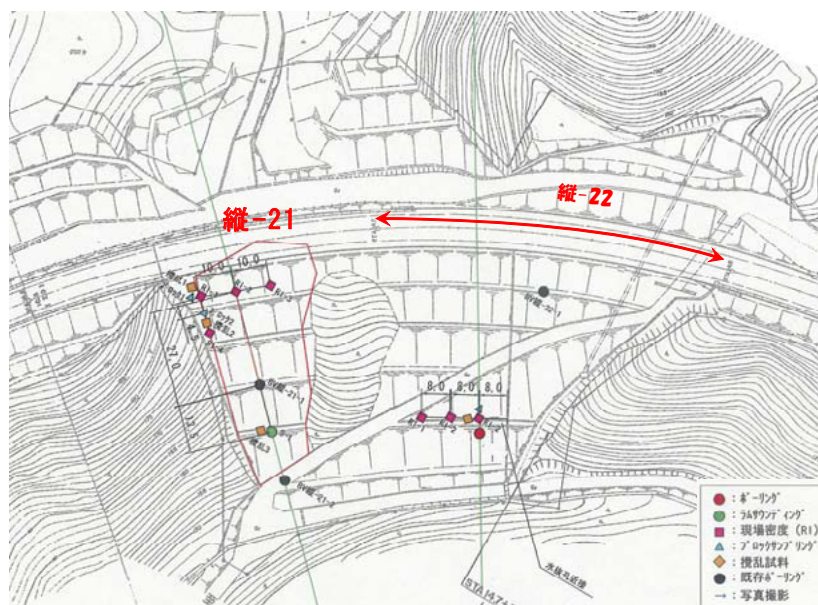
平面図（能登有料 七尾氏中島町小牧その8 14.8kp 縦-22）
